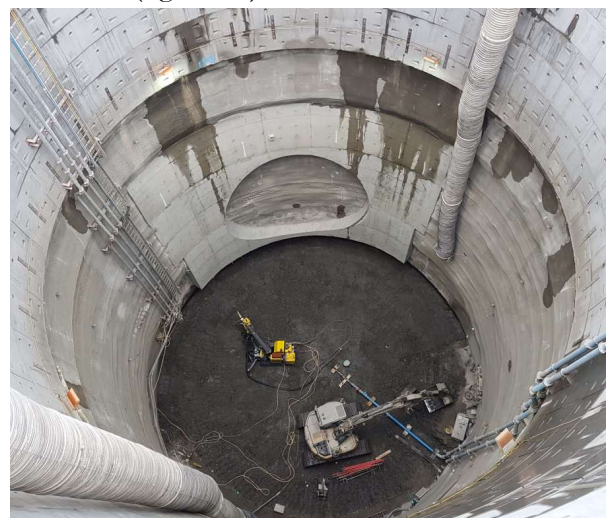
Sostenimiento de hormigón proyectado y recrecio de hormigón armado en la conexión de ventilación con el túnel
